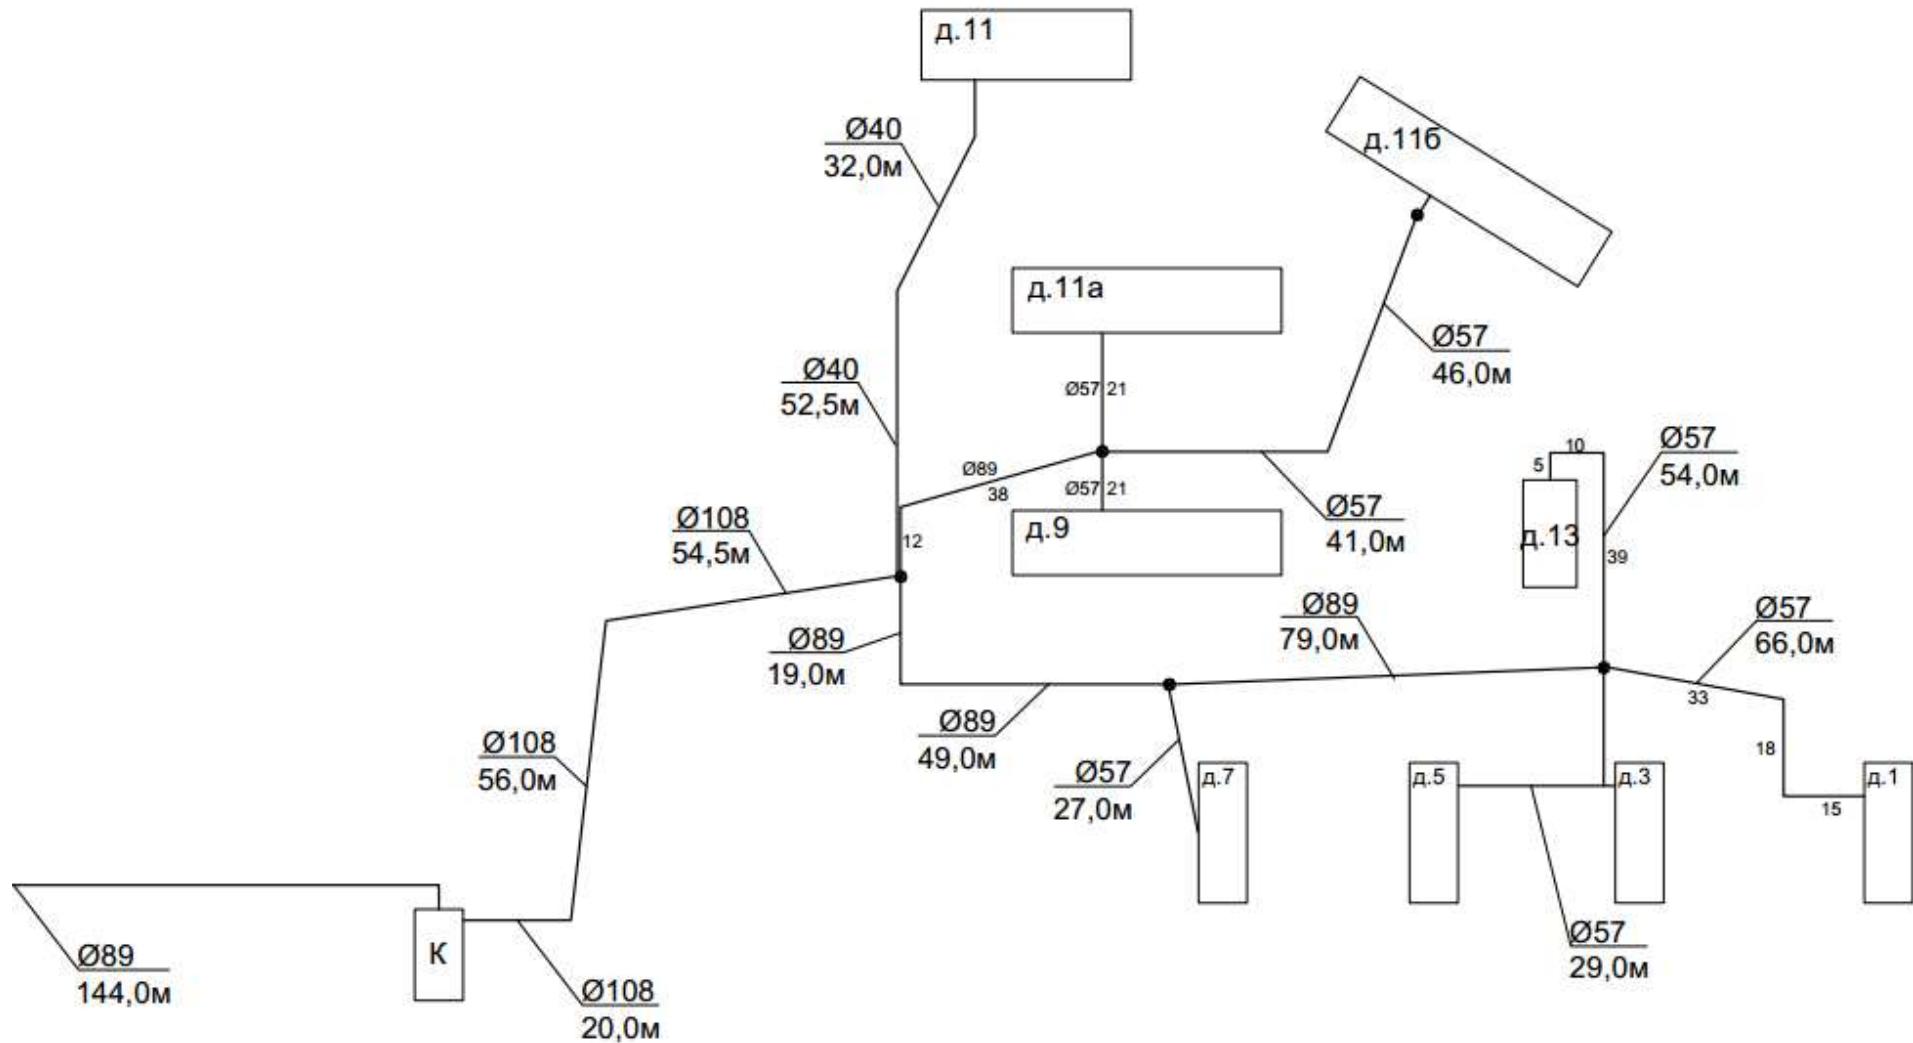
Схема тепловой сети котельной ПМК-2 (лист1)
